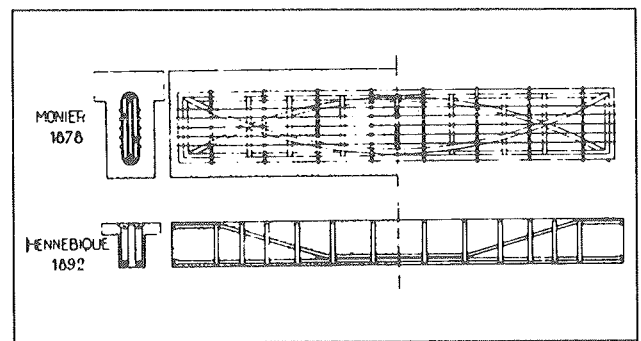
Schemi della disposizione delle armature nelle prime travi in c.a.
